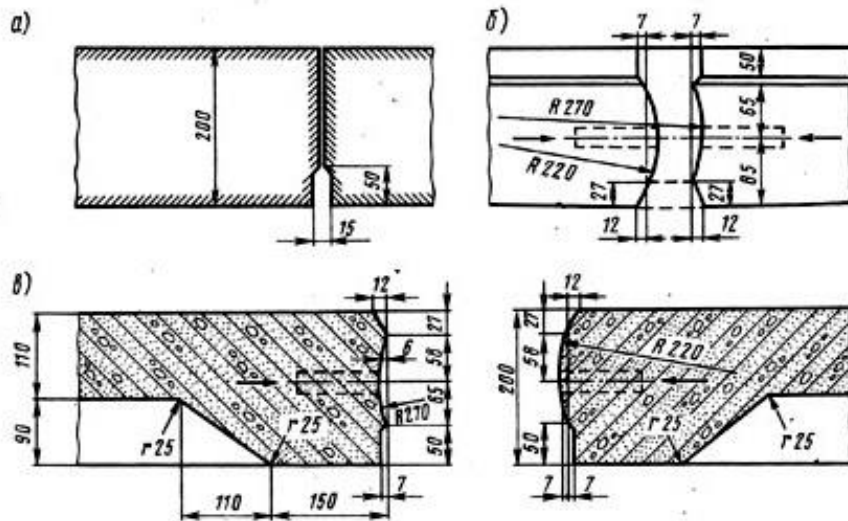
Конструкція поздовжніх стиків залізобетонних оправ:
